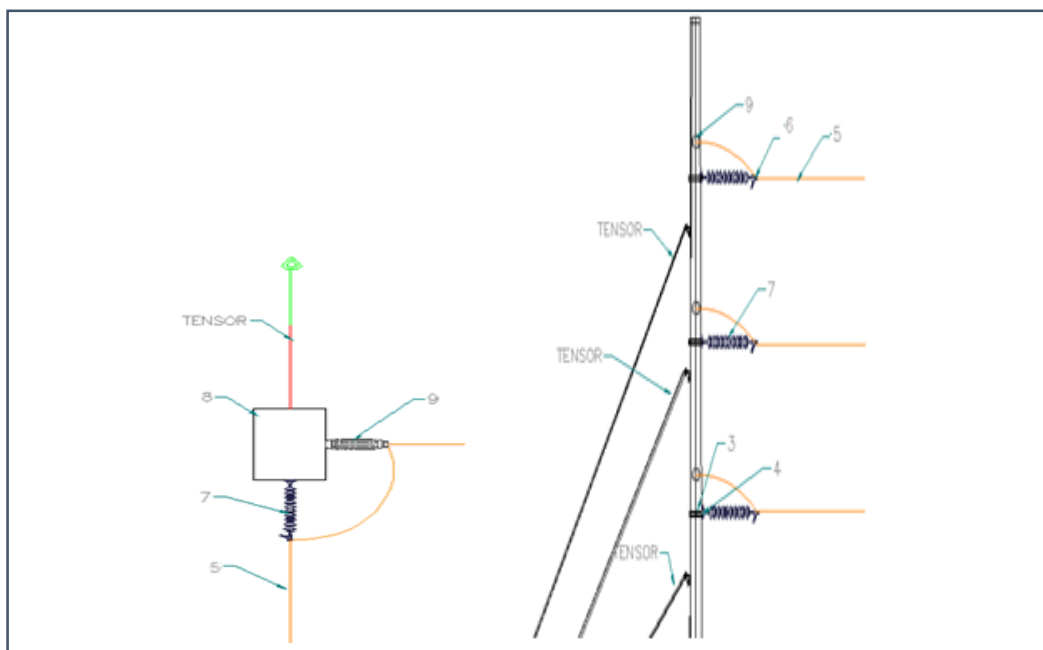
Vista de planta y lateral de la estructura de entrada a la barra
